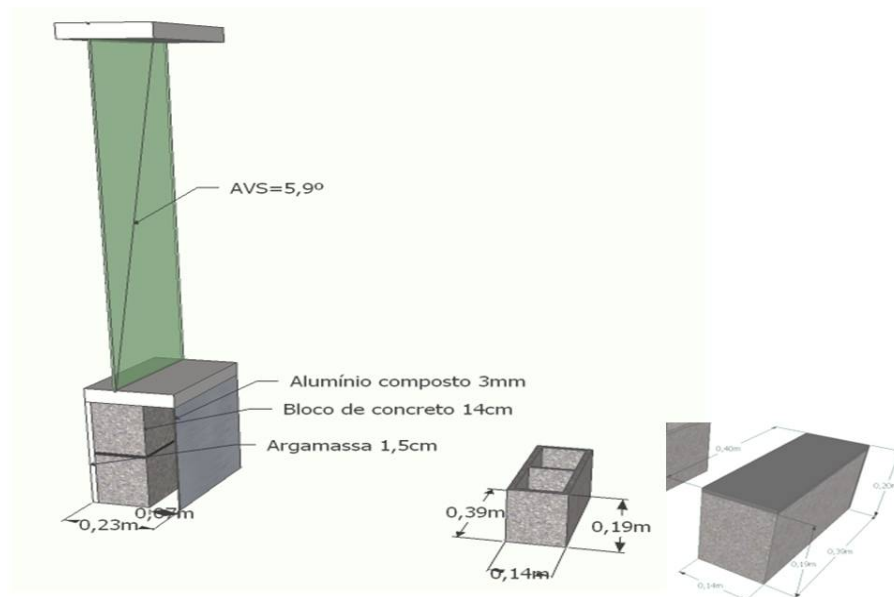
Esquema do sistema construtivo utilizado nas paredes.
